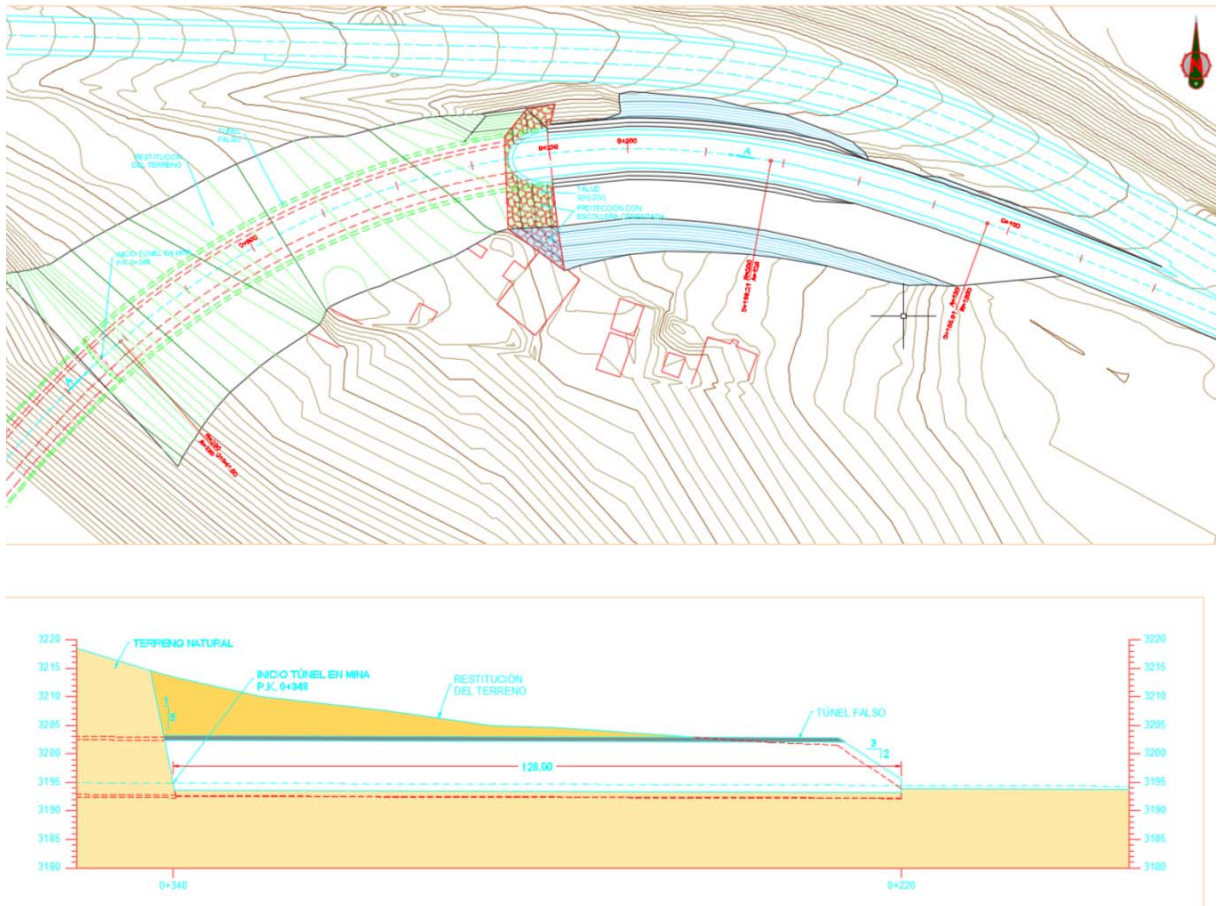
b.- Portal Argentino. Relleno en planta y alzado.
